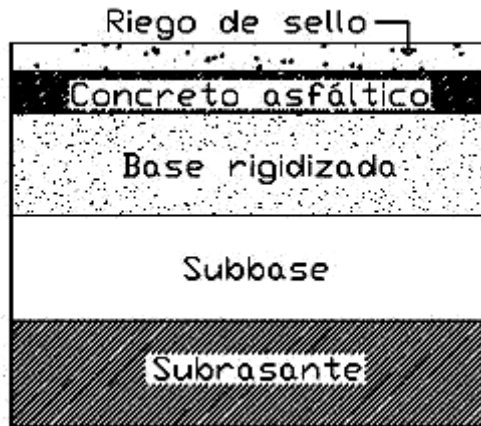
Estructuración de un pavimento flexible con base rigidizada
